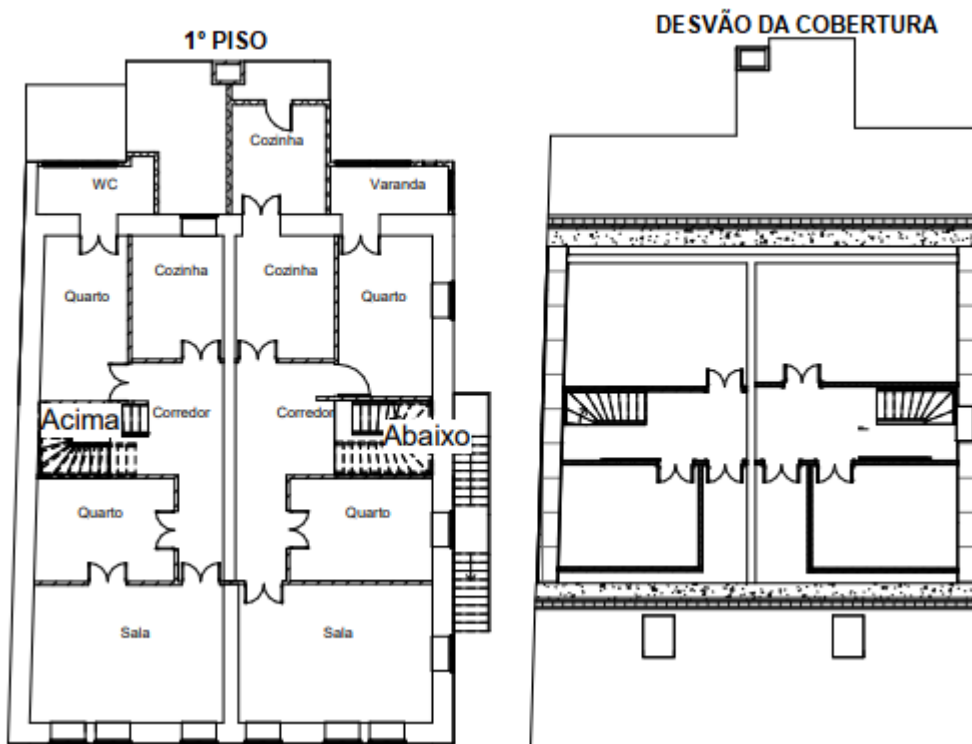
Planta baixa do 1º Piso e do Desvão da cobertura (sem escala)
